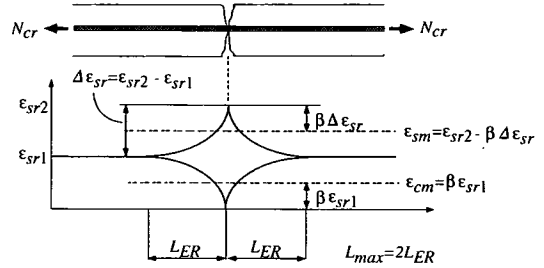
初期ひび割れ時の鉄筋、およびコンクリートのひずみ
